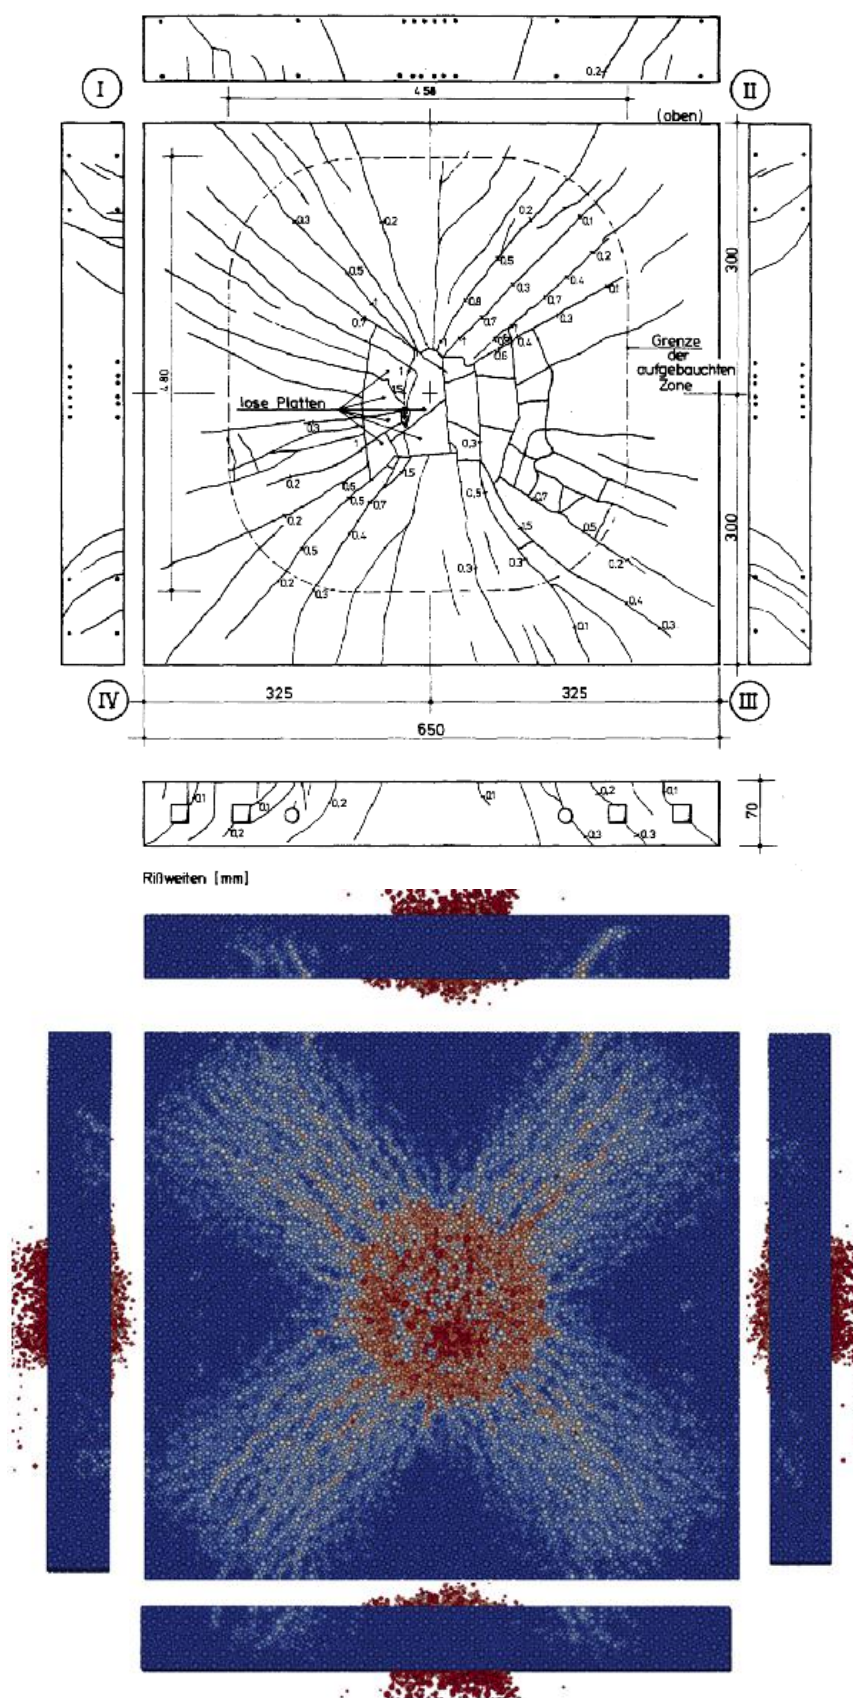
Etat de fissuration final de la face arrière et des faces latérales de la dalle dans l'essai et dans le calcul.
